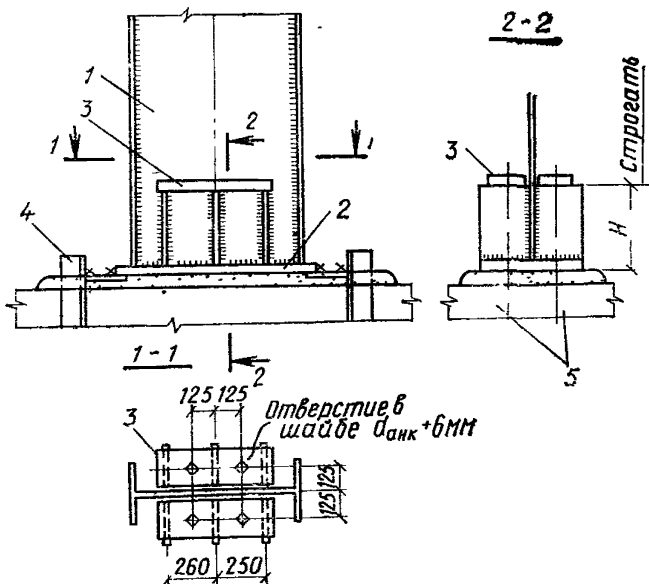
Опираение колонны на фундамент при отрывающем усилии, равном или свыше 70 тс
